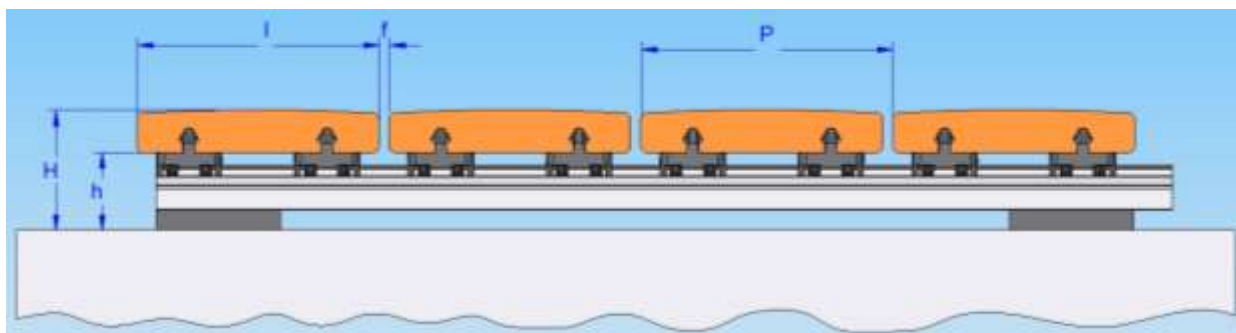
in alto, sezione trasversale dei listoni in legno massello fissati su sottostruttura in alluminio KIT 60 ad altezza fissa
